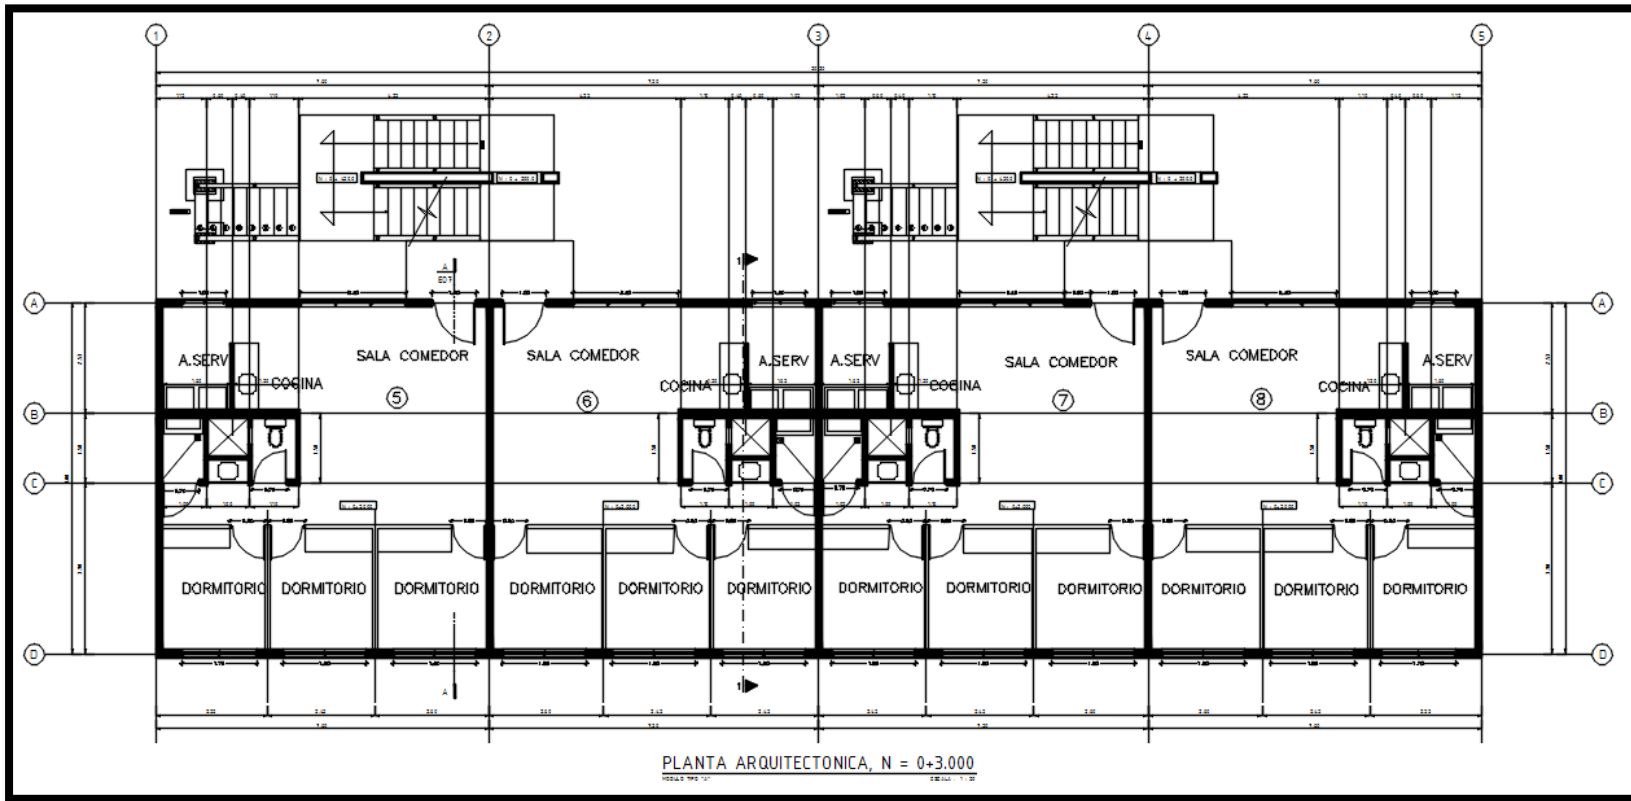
Planta Arquitectónica (Elevación 0 + 3.000)
